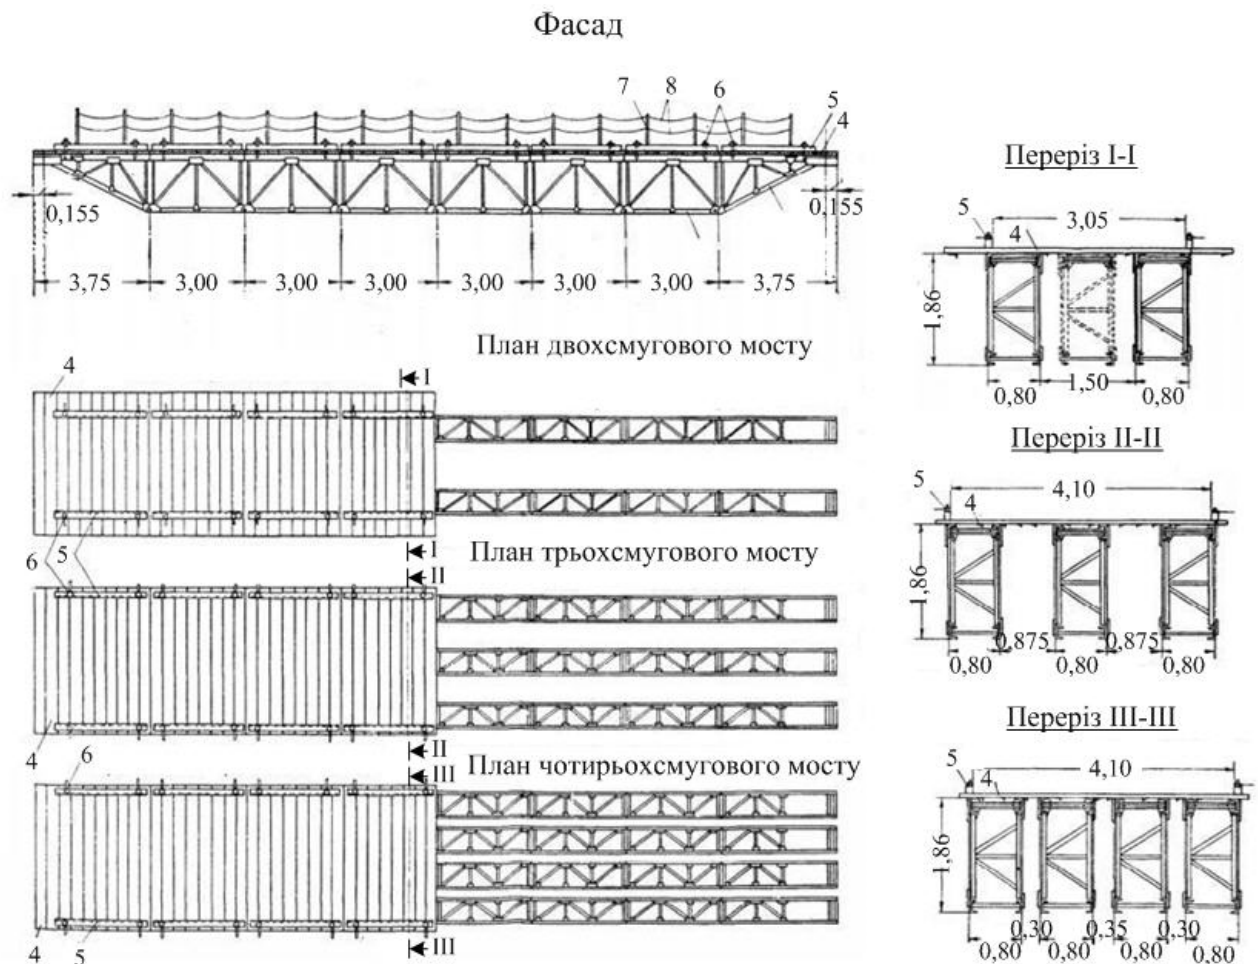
Збірні схеми прогонової будови: 1 – проміжні секції ферми; 2 – кінцеві секції ферми; 3 – вузловий штир; 4 – настилочний щит; 5 – колесобій; 6 – пажильний болт; 7 – перильна стійка; 8 – перильний канат
